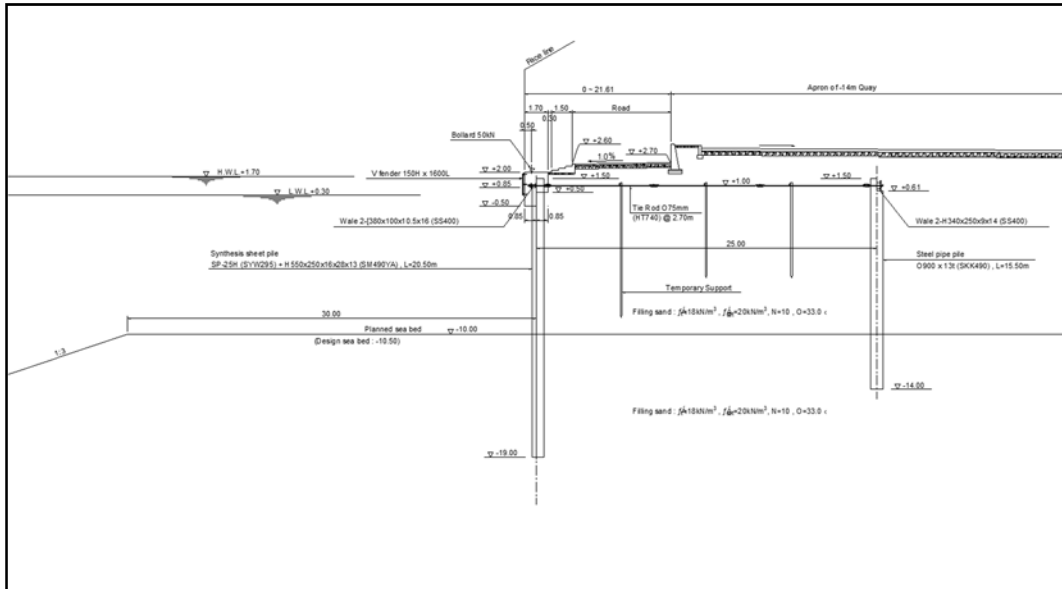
Profil type du nouveau quai sud de -10 m pour bateaux-pilotes No.1
